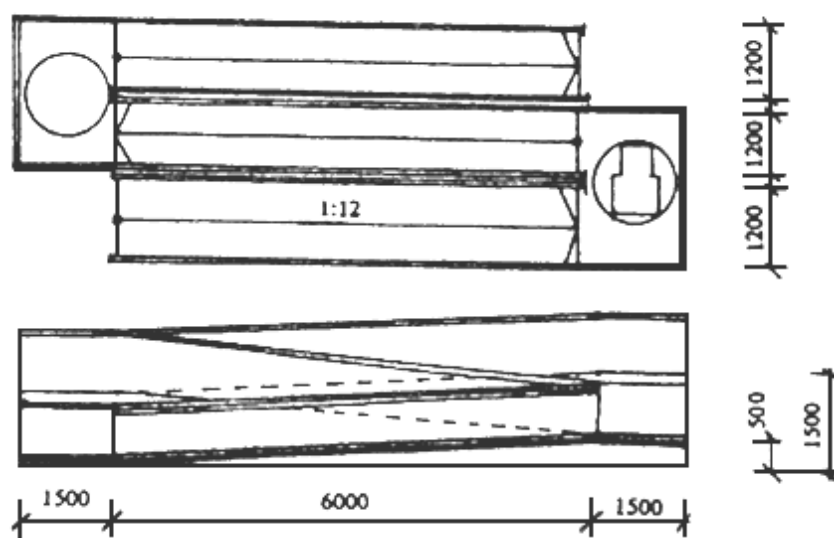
Устройство пандуса на высоту 1500 мм. План. Разрез
